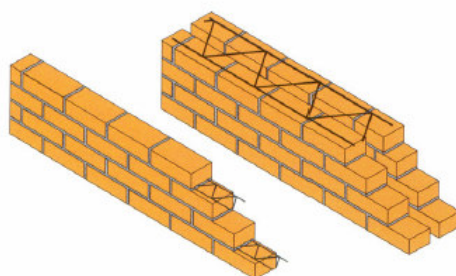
Exemplos da aplicação de armaduras em paredes simples e duplas
